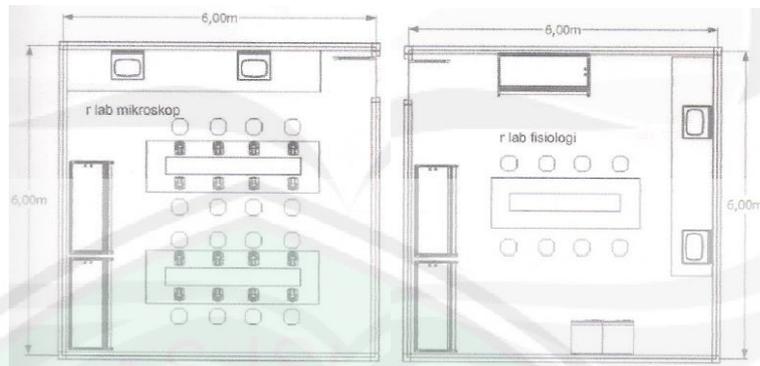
Gambaran Laboratorium Ruang Steril
